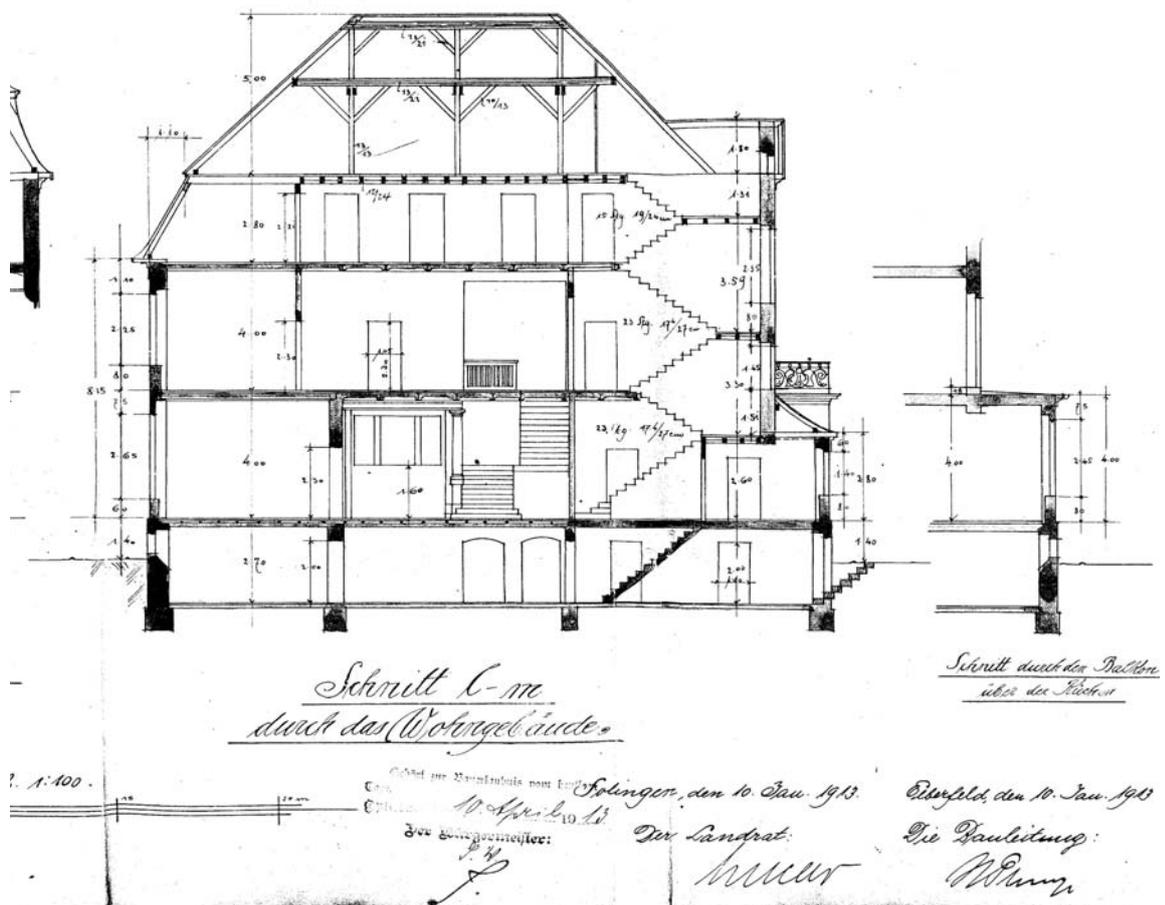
H. Plange, Schnitt durch das Wohngebäude, 1913
